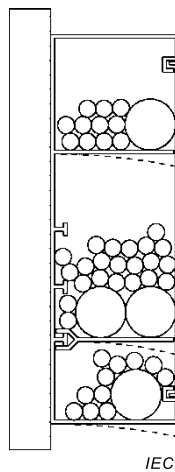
SG/SCP de section transversale rectangulaire ou similaire
